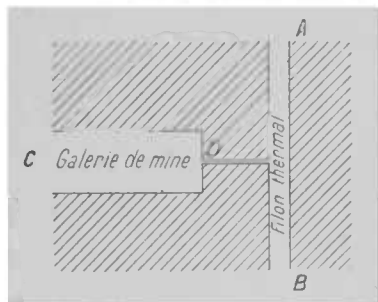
Plan d'une galerie de captage, accédant au filon thermal par un sondage horizontal.
